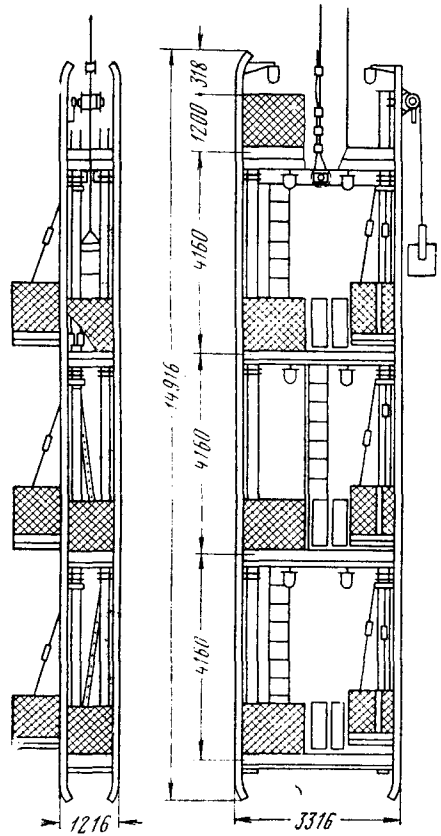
Люлька конструкции треста Кривбассшахтопроходка для навески проводников
